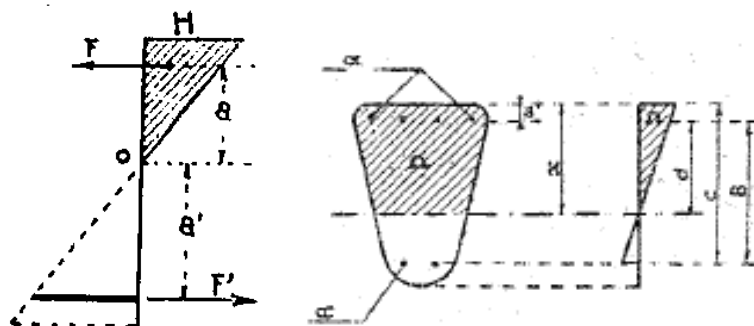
Distribución de tensiones en el hormigón (DGA, 1941)
